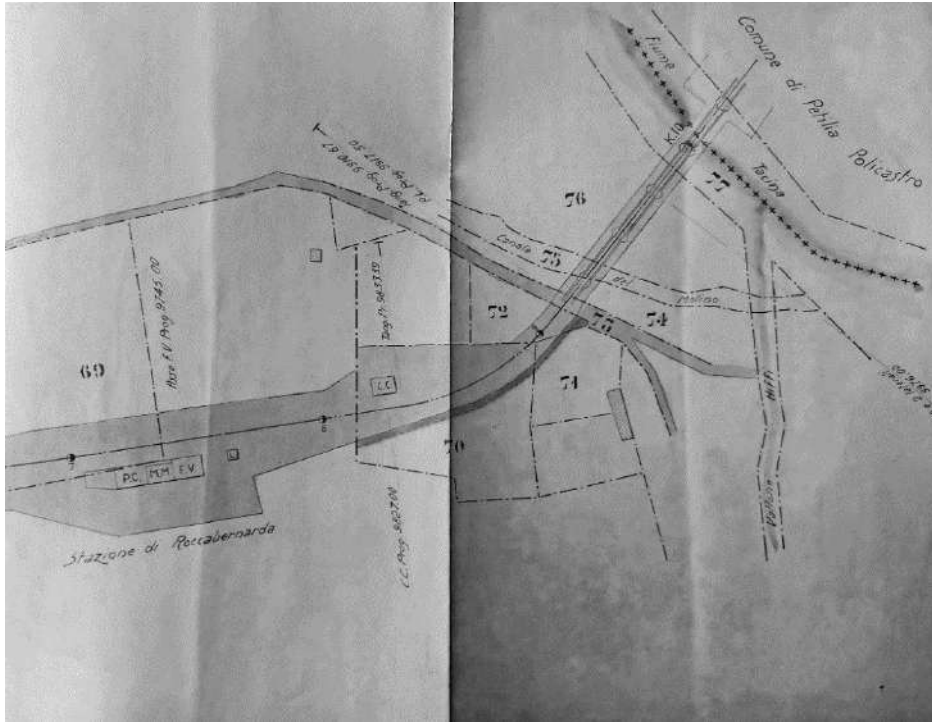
Piano di esecuzione di esproprio, Viadotto sul fiume Tacina
